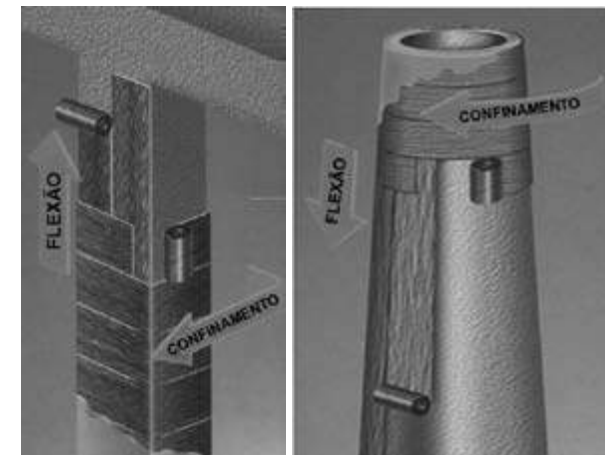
Reforço de pilares à flexão e confinamento.
